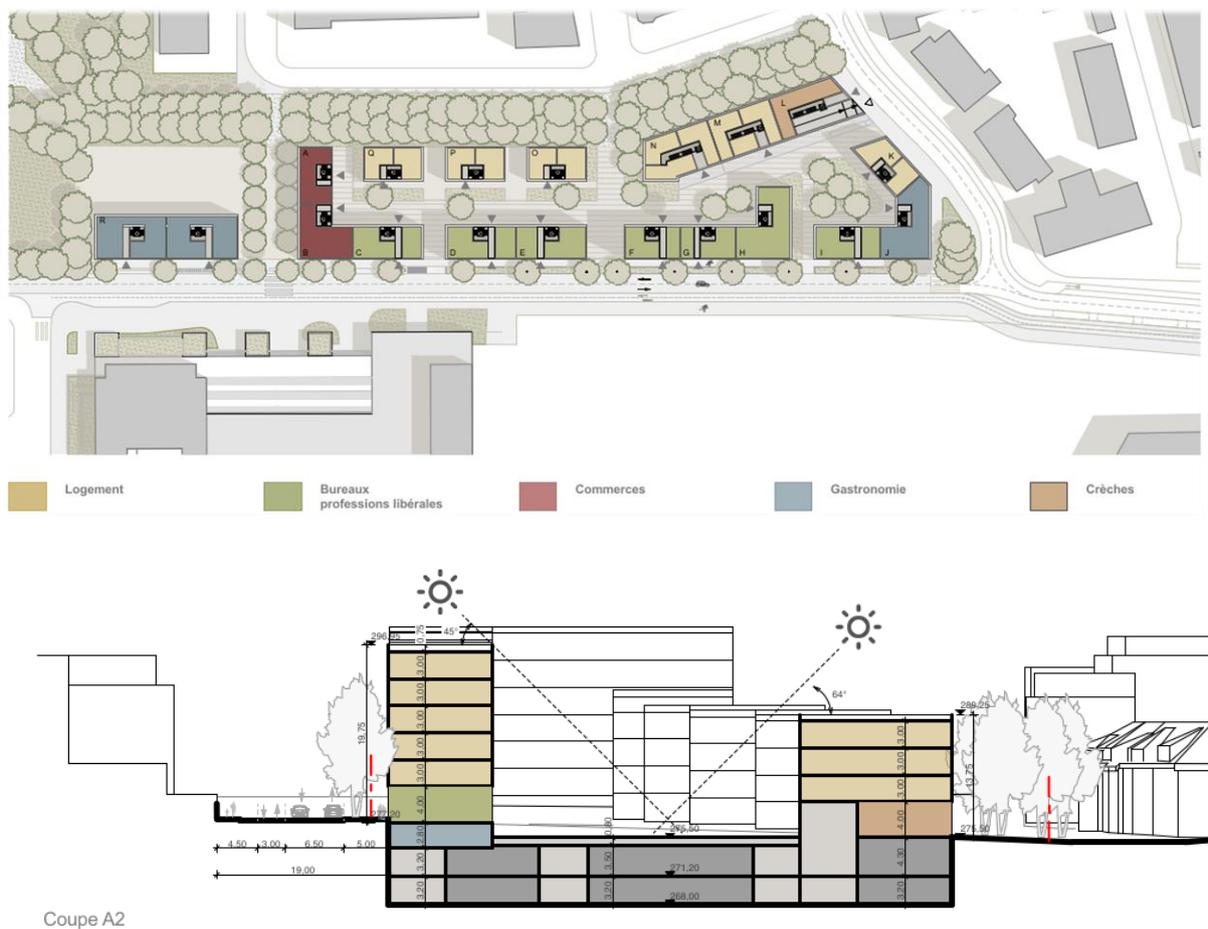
Plan Schéma de rez-de-chaussée et coupe transversale (Extrait étude préliminaire – Christian Bauer et Associés Architectes S.A.).
